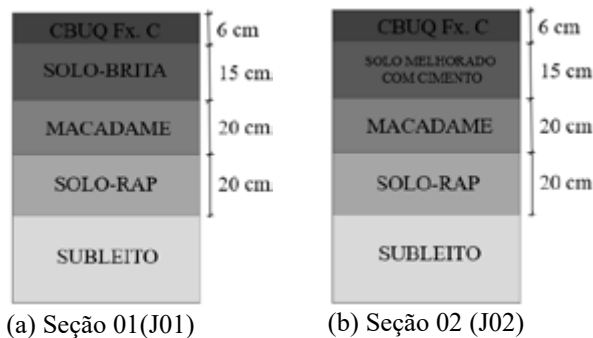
Seções experimentais do presente estudo (após a reconstrução do pavimento)
